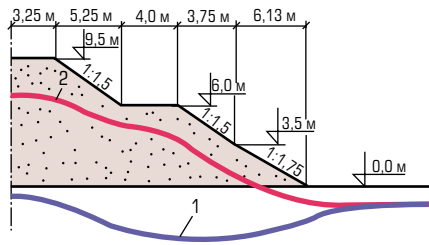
Положение границы оттаивания грунтов в основании высоких насыпей: 1 — без устройства теплоизоляции; 2 — при укладке теплоизоляции на откосах и берме
